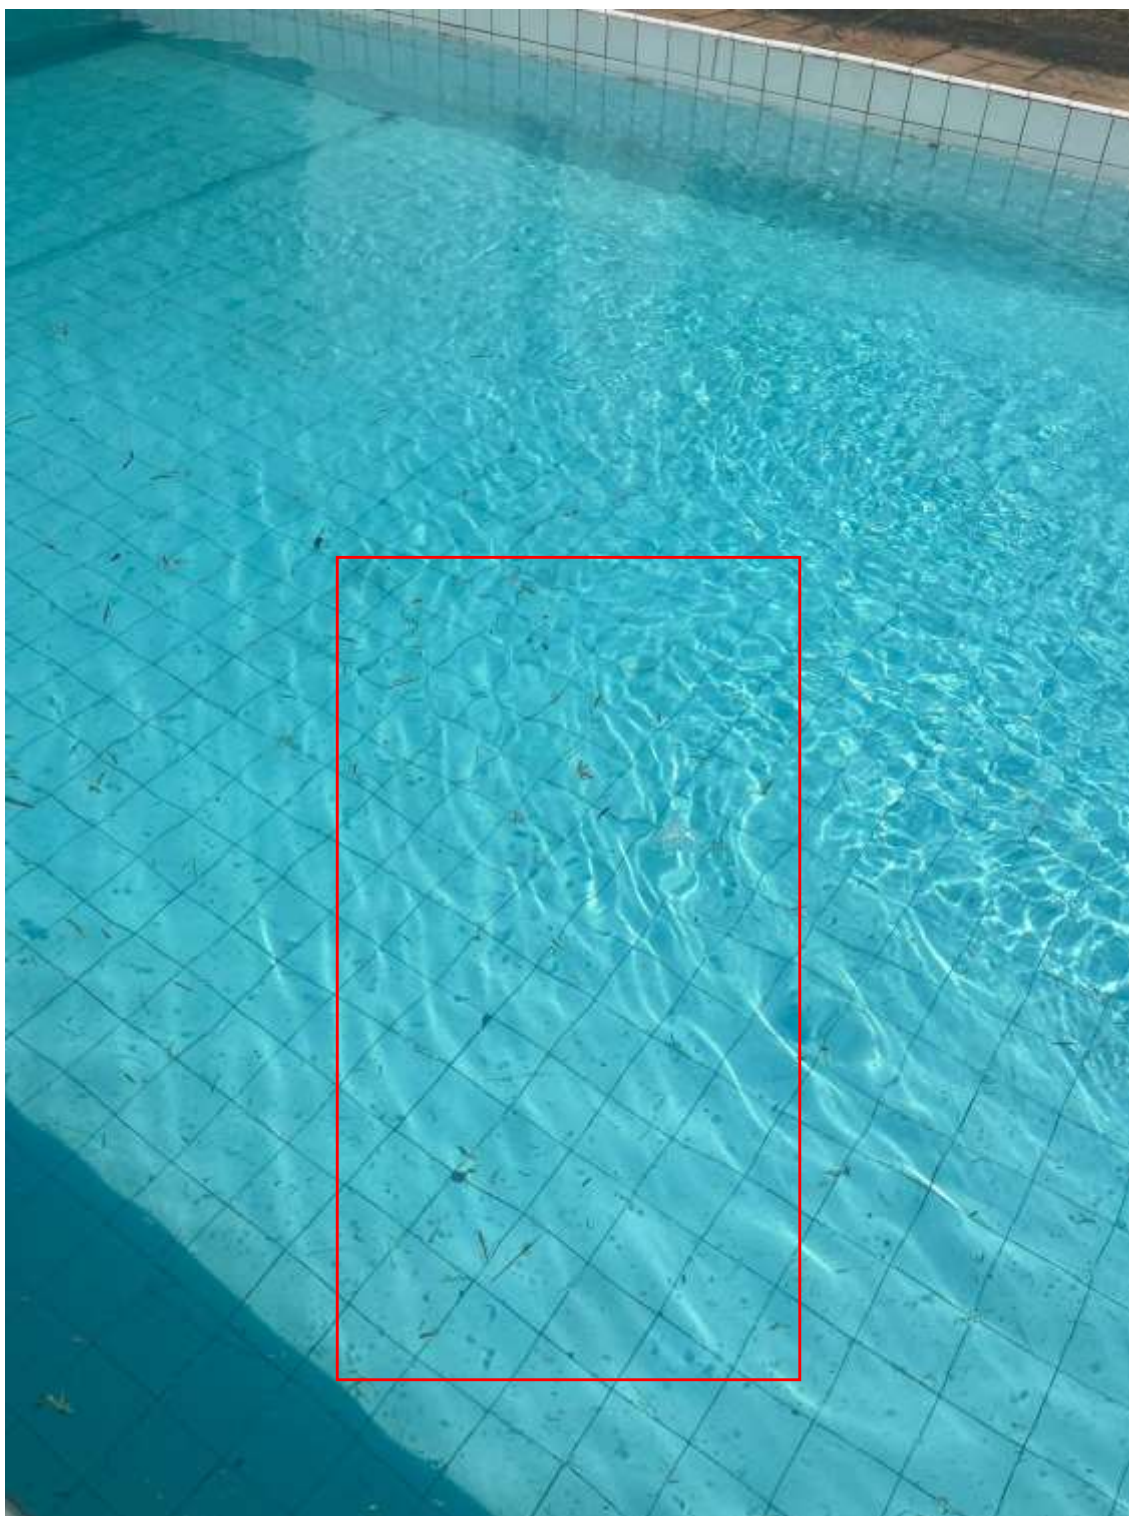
Detalhe da piscina com constatação de exemplo de rachaduras, conforme marcação em vermelho.
